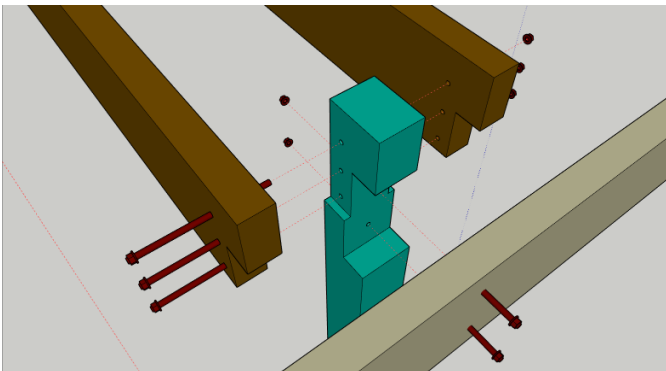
Узел крепления к колонне обвязочных балок и балок покрытия
